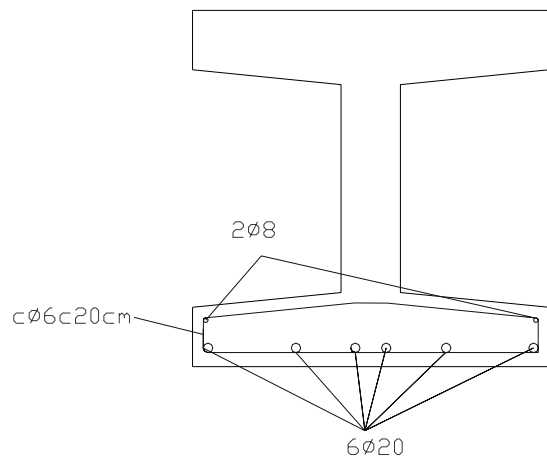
Armado tipo de la viga V1-SFRC de la D3
